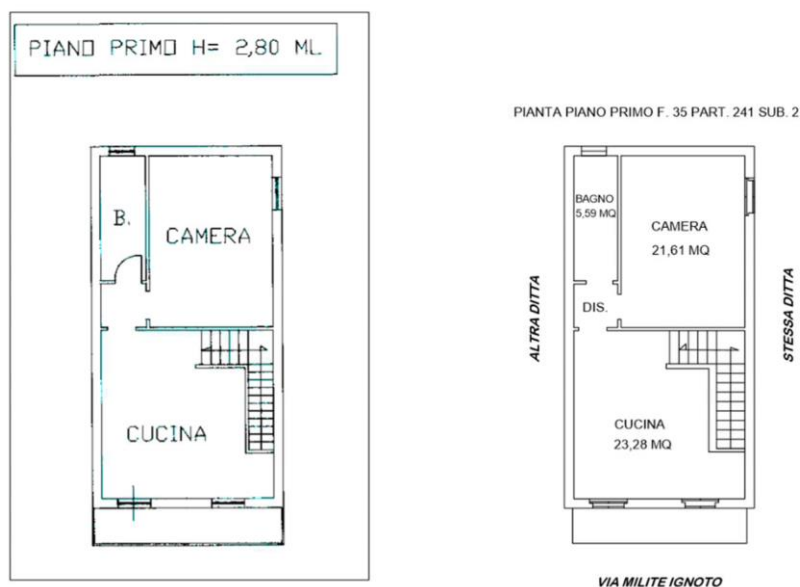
Planimetria catastale e stato di fatto del Piano Primo
